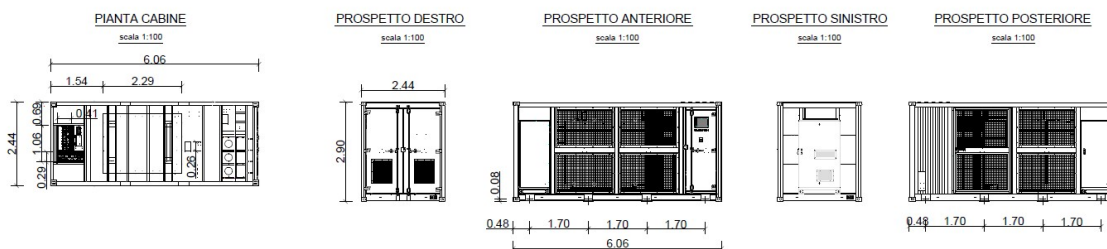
Pianta, sezioni e prospetti della cabina di trasformazione
